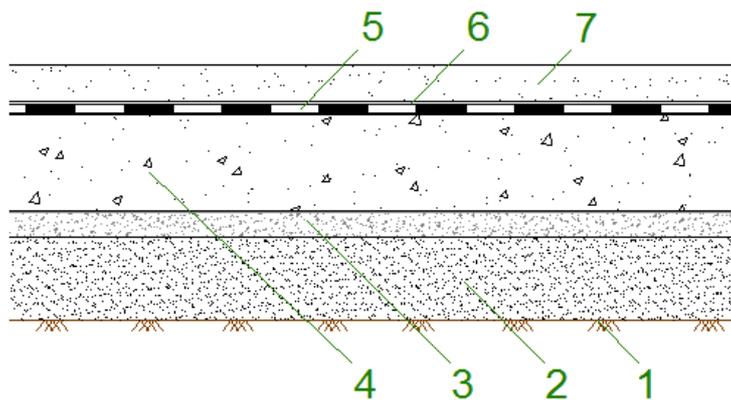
Betonagem da laje de fundo depois de impermeabilizado o ensoleiramento geral na face superior [w₅₃]
